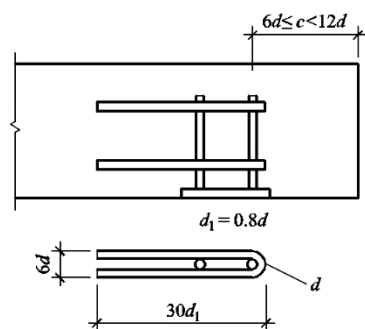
锚固边排锚筋的附加构造钢筋
